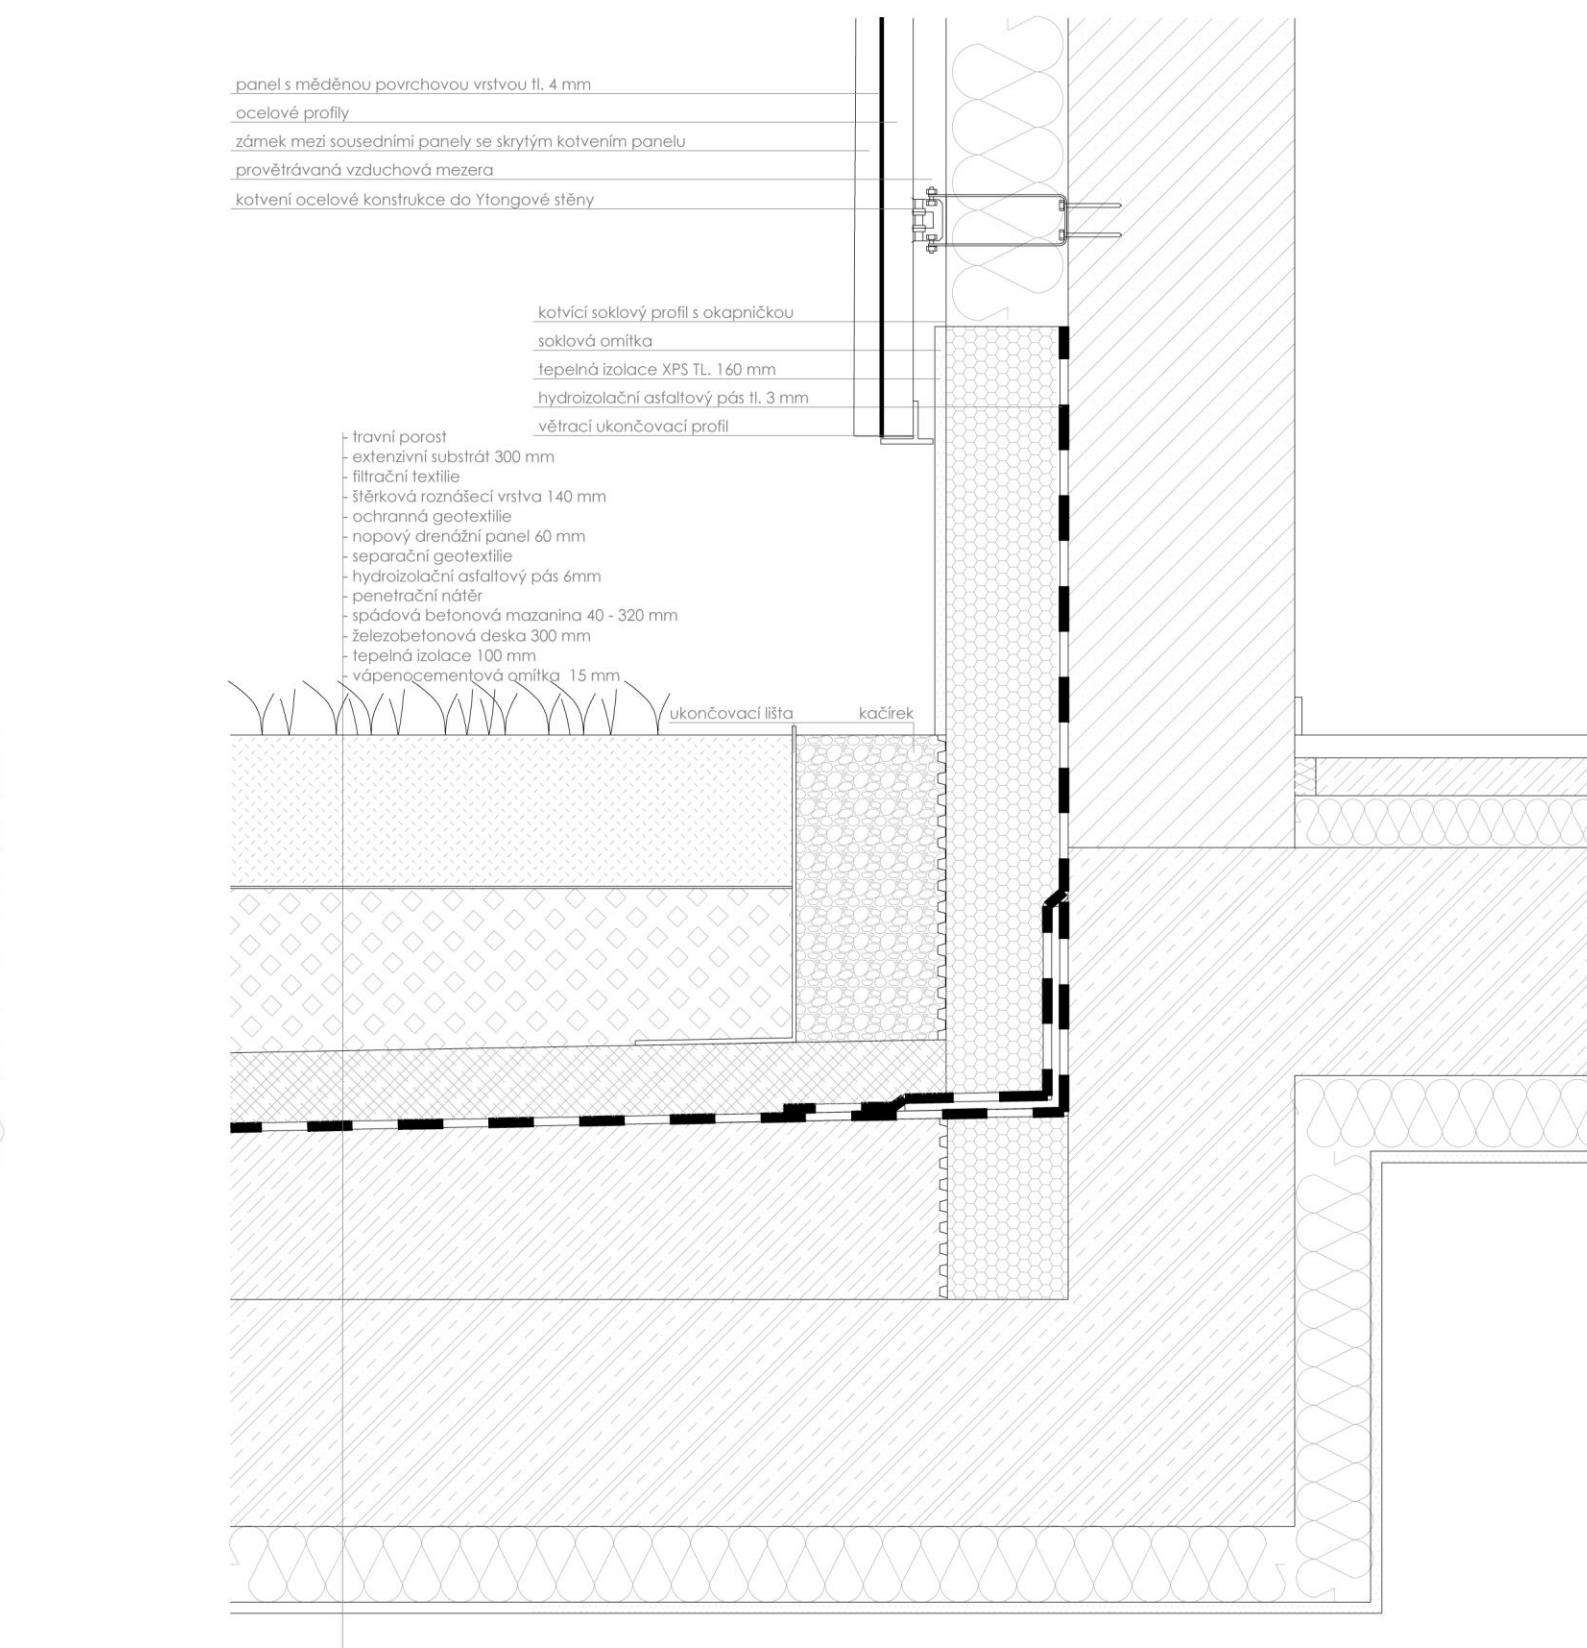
ATIKA S ODKLADEM A NADPRAŽÍ
